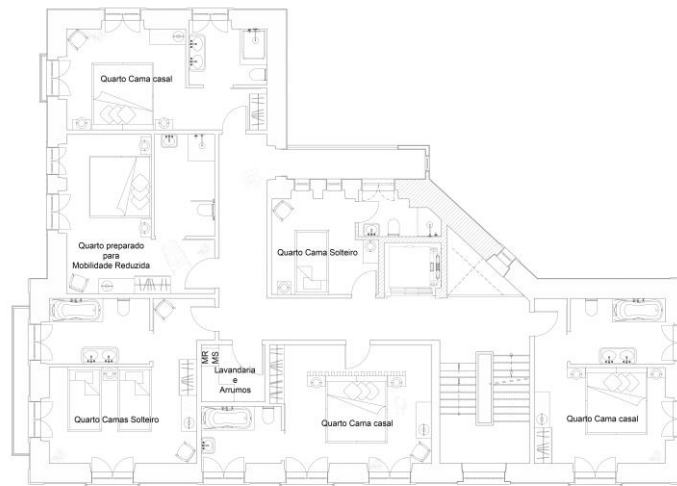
Planta de Zonamentos Piso 2. Fonte: Autor
